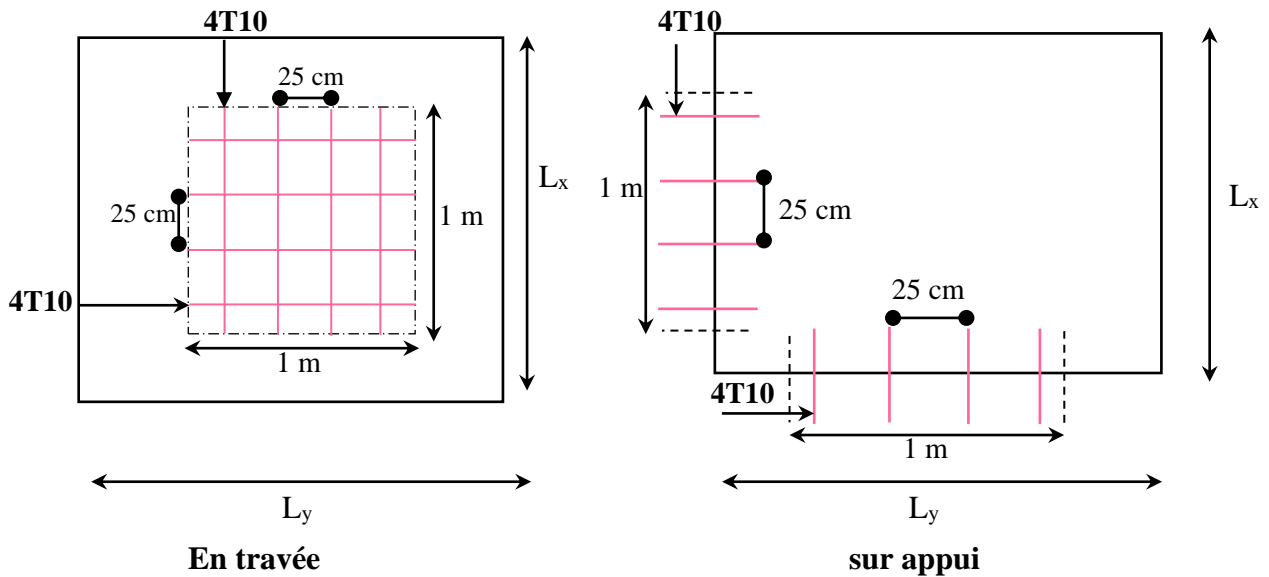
Ferrailage d'une bonde de 1 m du balcon.
